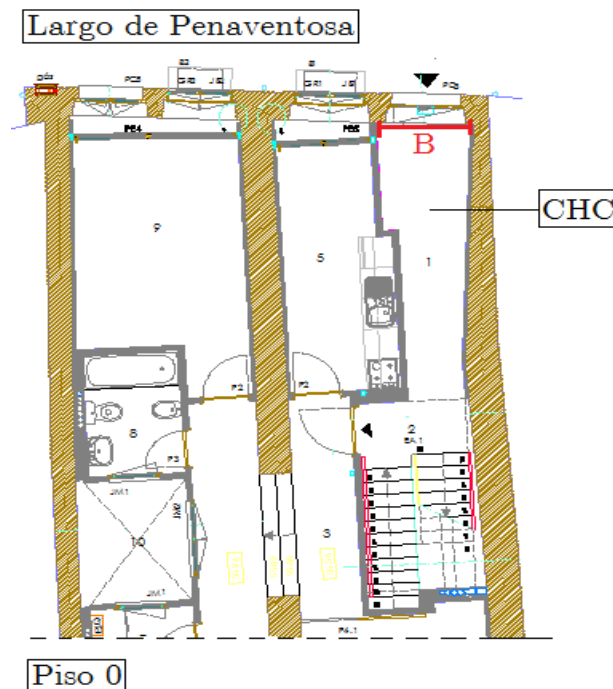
Comprimento da ligação da parede exterior com pavimento sobre a CHC do piso 0 -
